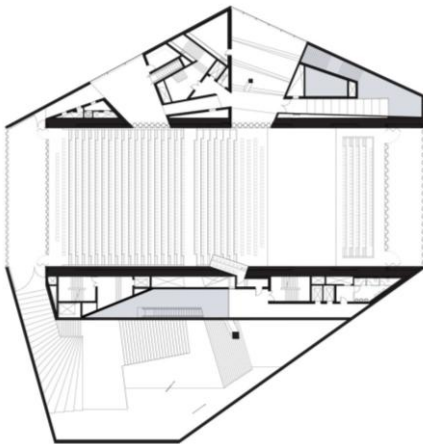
Planta correspondente á sala de concertos central da Casa a Música
